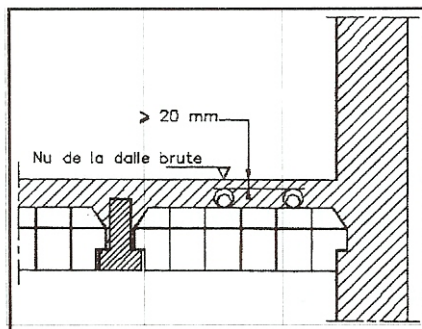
Exemples de canalisations incorporées dans un plancher à dalle pleine (encastrement ou enrobage) -coupes verticales/cas de tuyauteries nues
